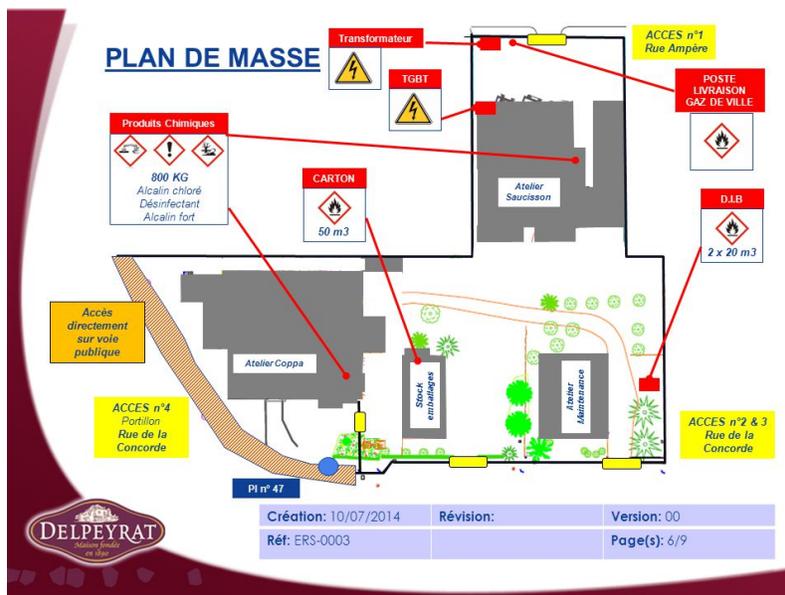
Extrait d'un plan ETA.RE d'un ERP
